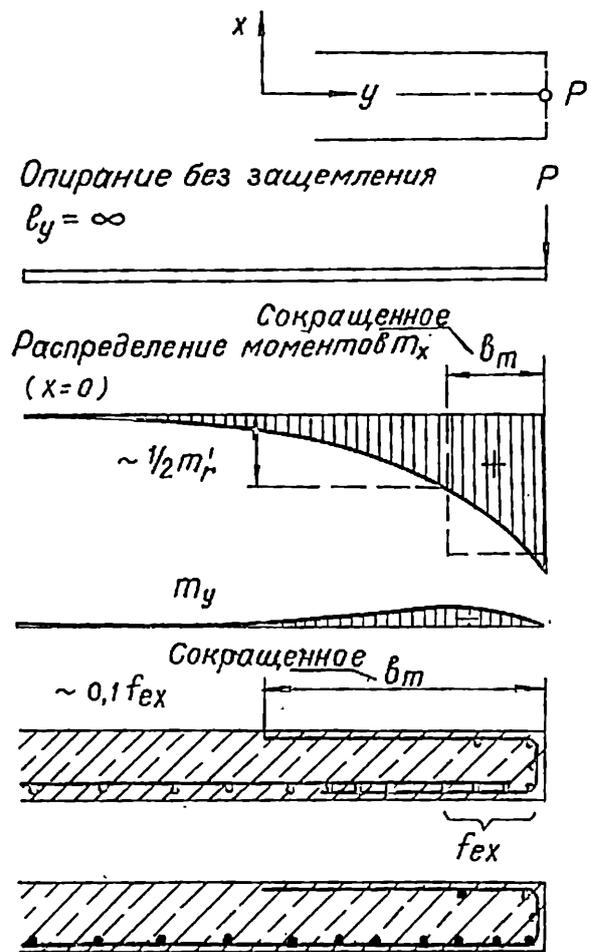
16. Сосредоточенная нагрузка P на краю плиты с опорами по двум сторонам
